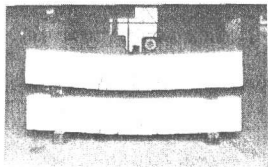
川砂コンクリートの終局破壊状況 写真-2 水砕砂コンクリートの終局破壊状況
